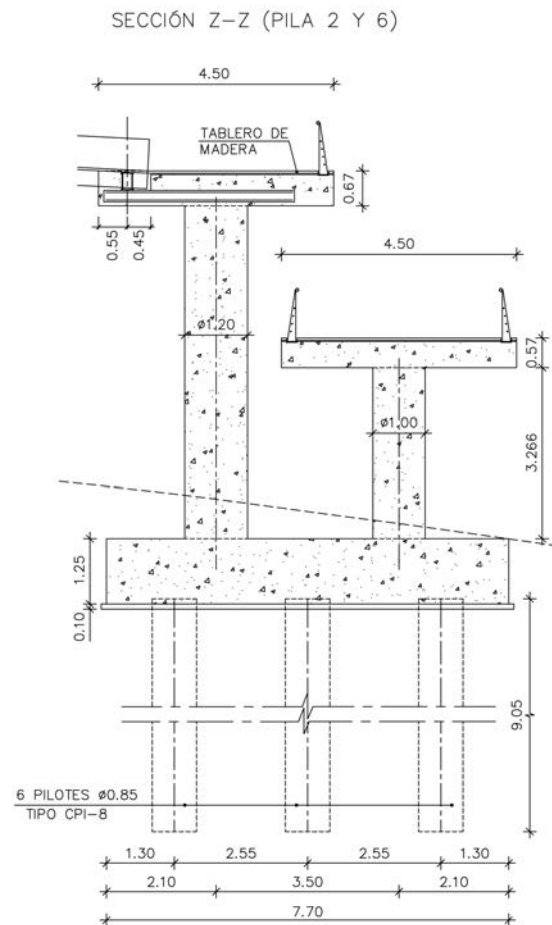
Pasarela de La Triola: sección de las pilas 2 y 6.
